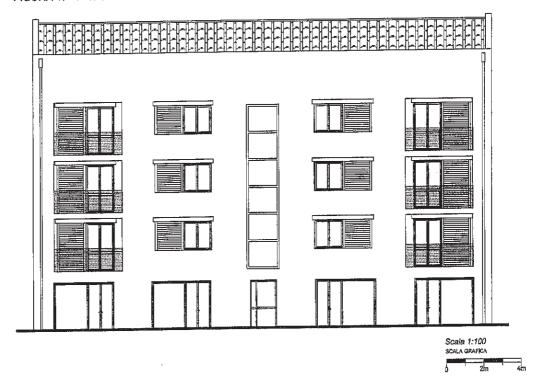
PROSPETTO LATERALE del fabbricato residenziale tipo.
